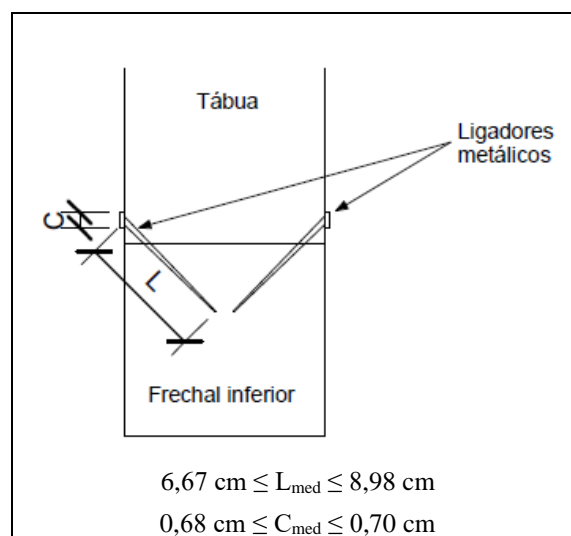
Pormenor de ligação das tábuas verticais / diagonais ao frechal inferior
